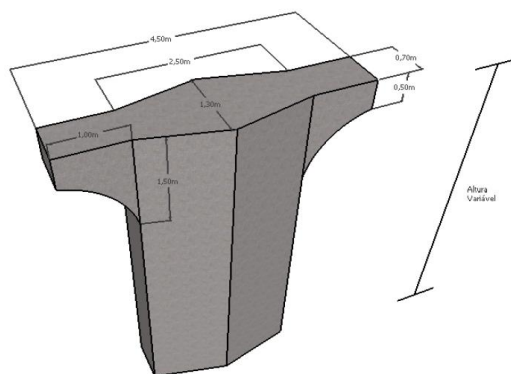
Panorama dos pilares dos viadutos A e B em 3D
